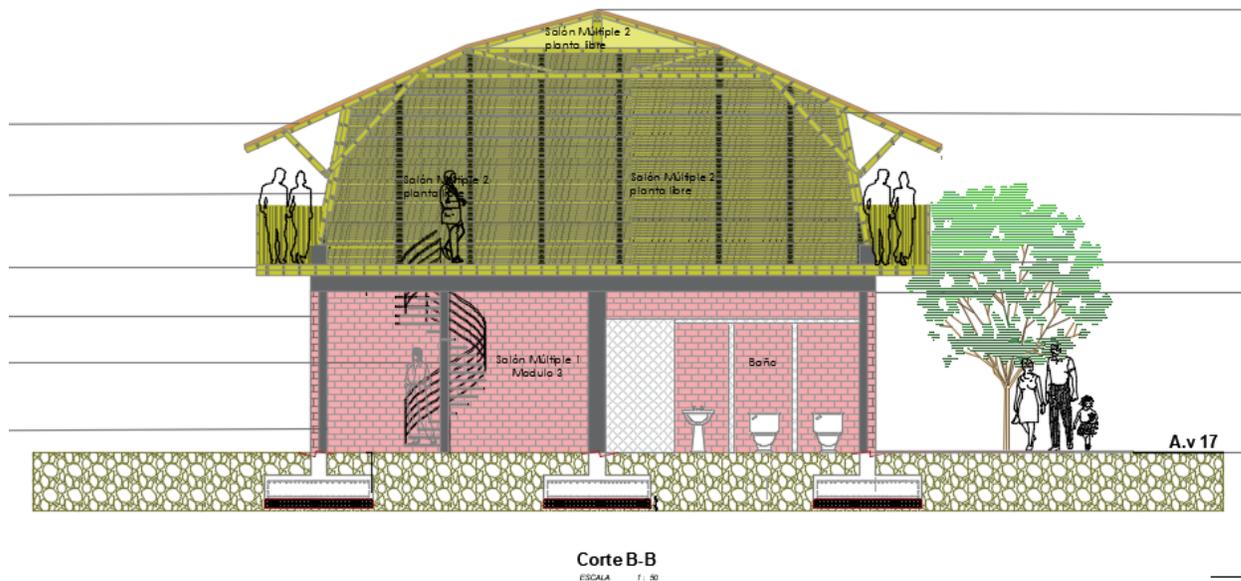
Corte transversal- primer piso a porticado y segundo piso modulo en guadua.
